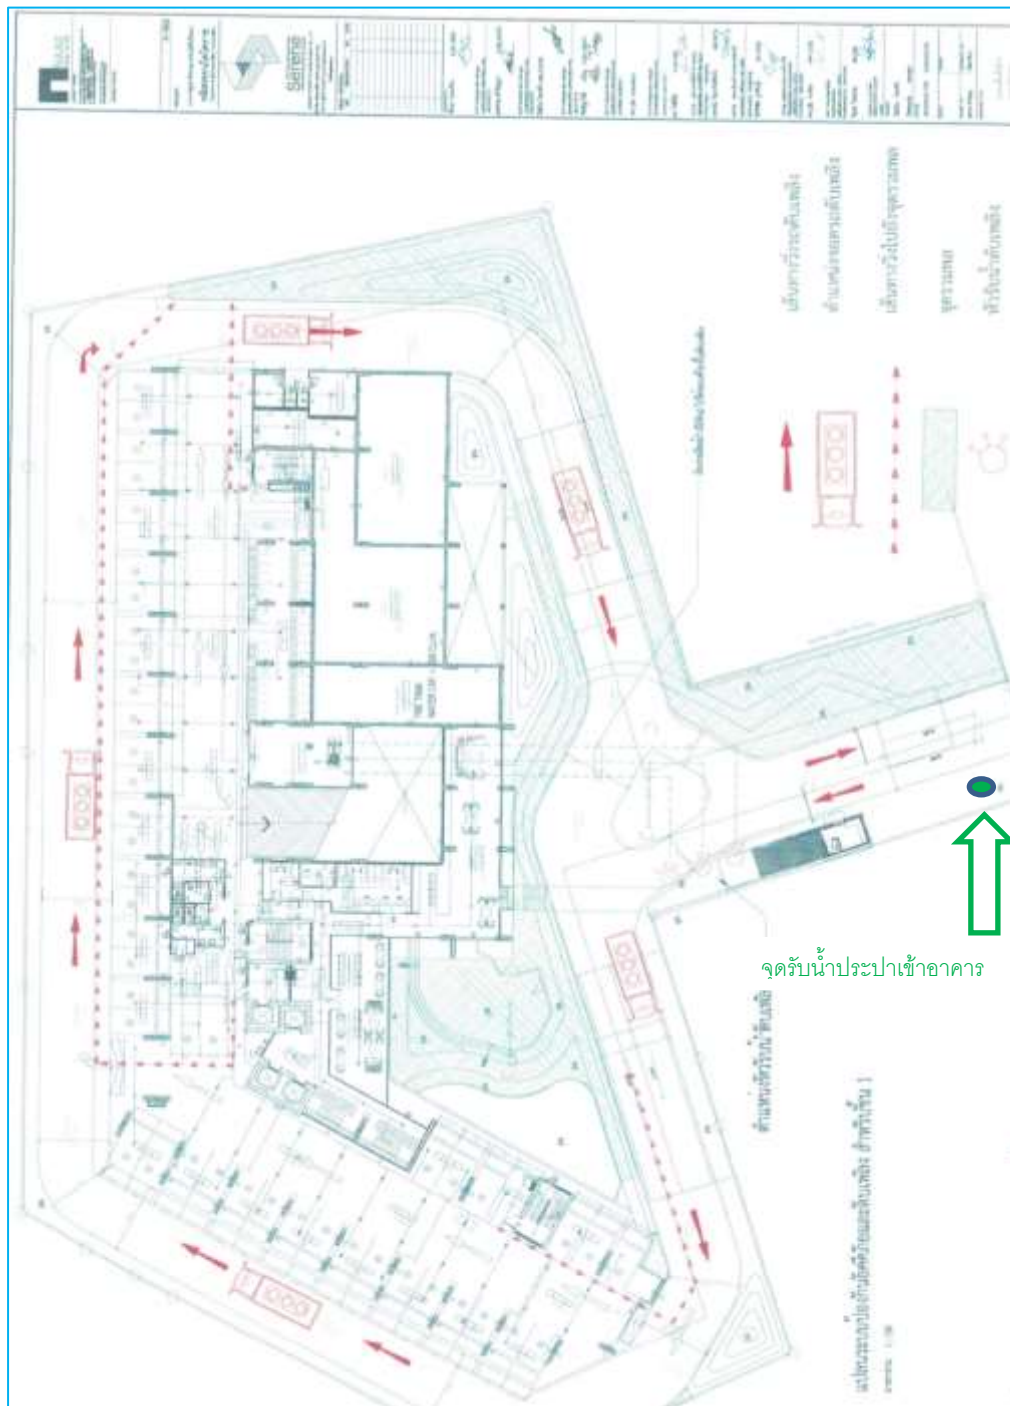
ผังบริเวณโครงการ
